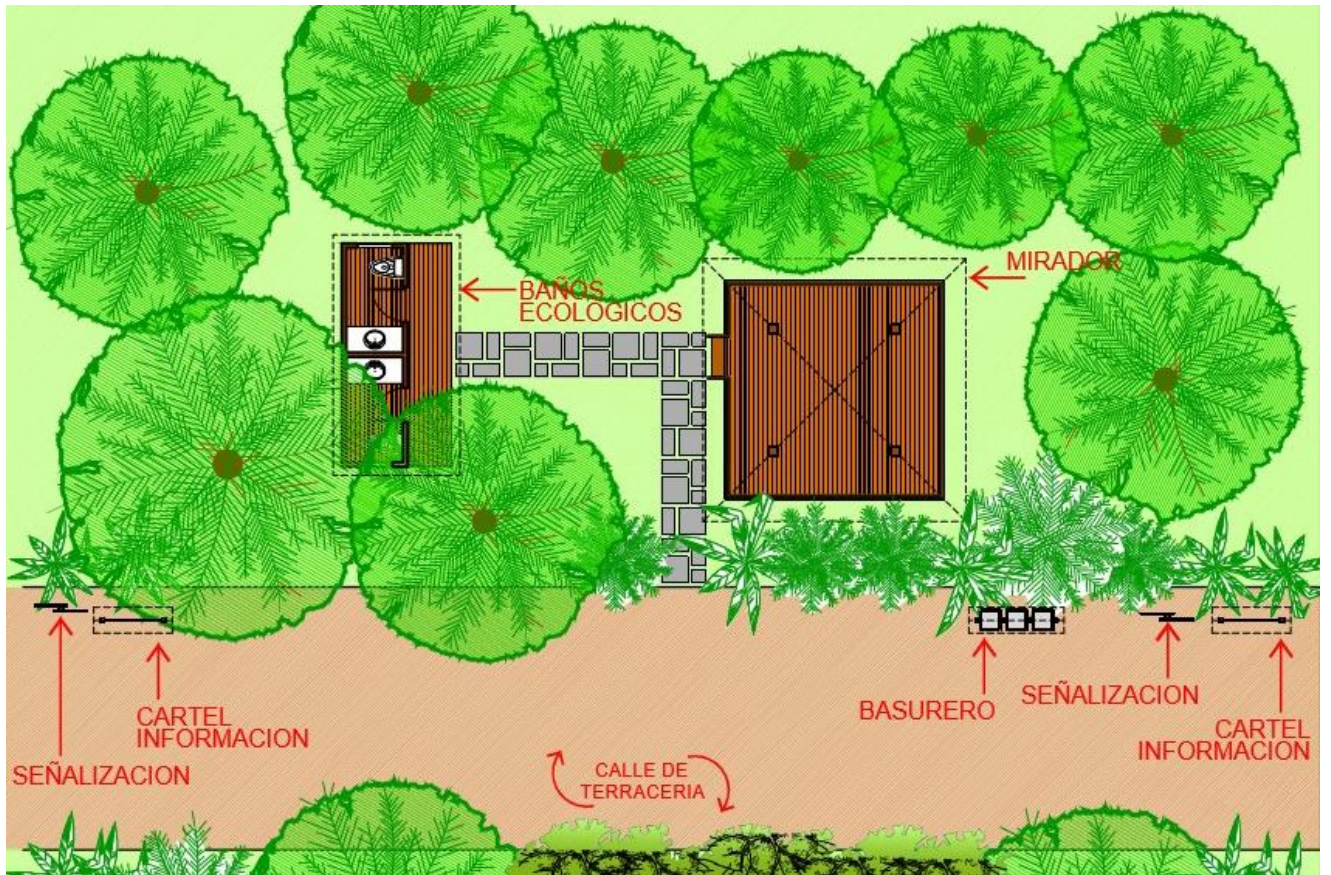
PLANTA SENDERO TÍPICO
